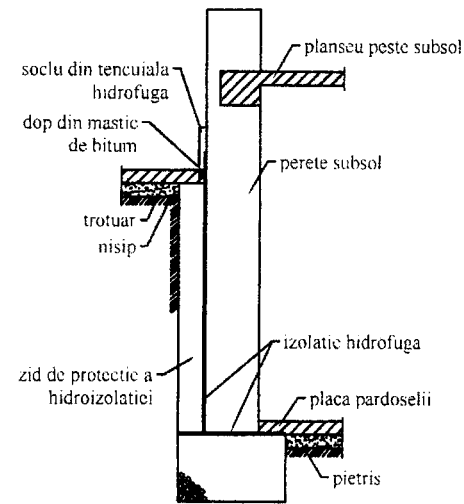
Fundațiile continue sub pereții exteriori ai clădirilor cu subsol
